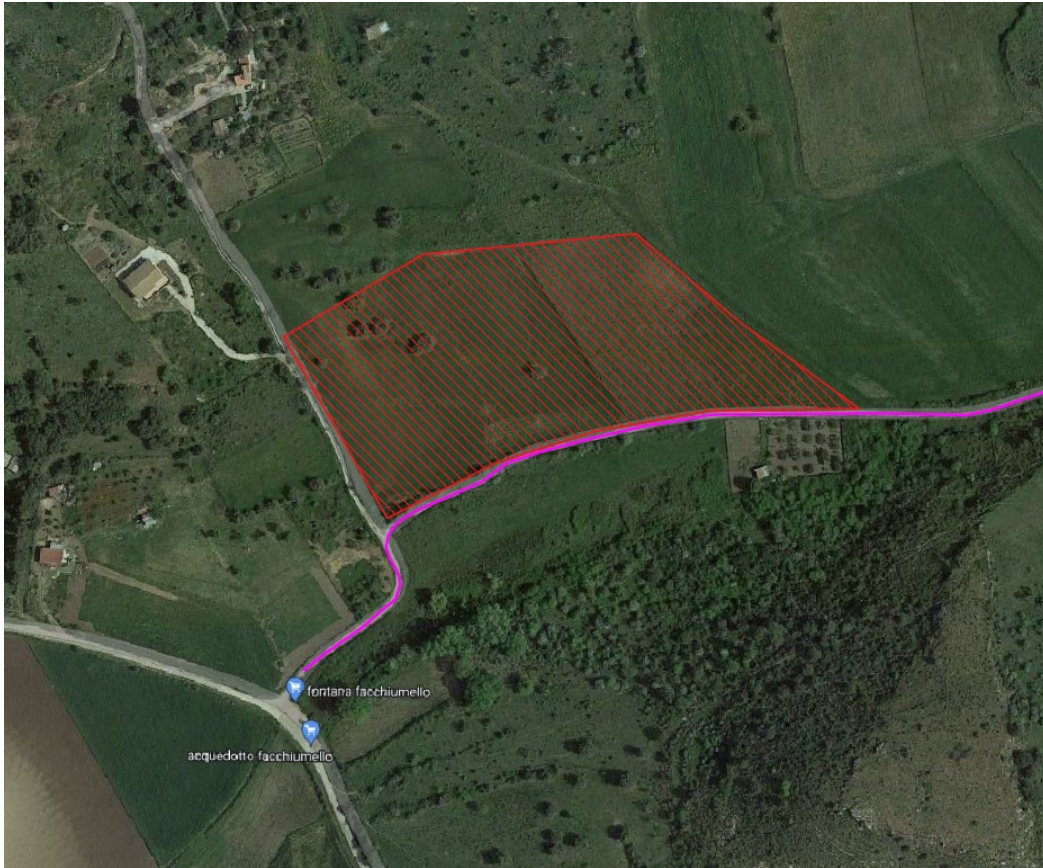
Area di cantiere officina e deposito (in magenta la Viabilità 1 da adeguare)
